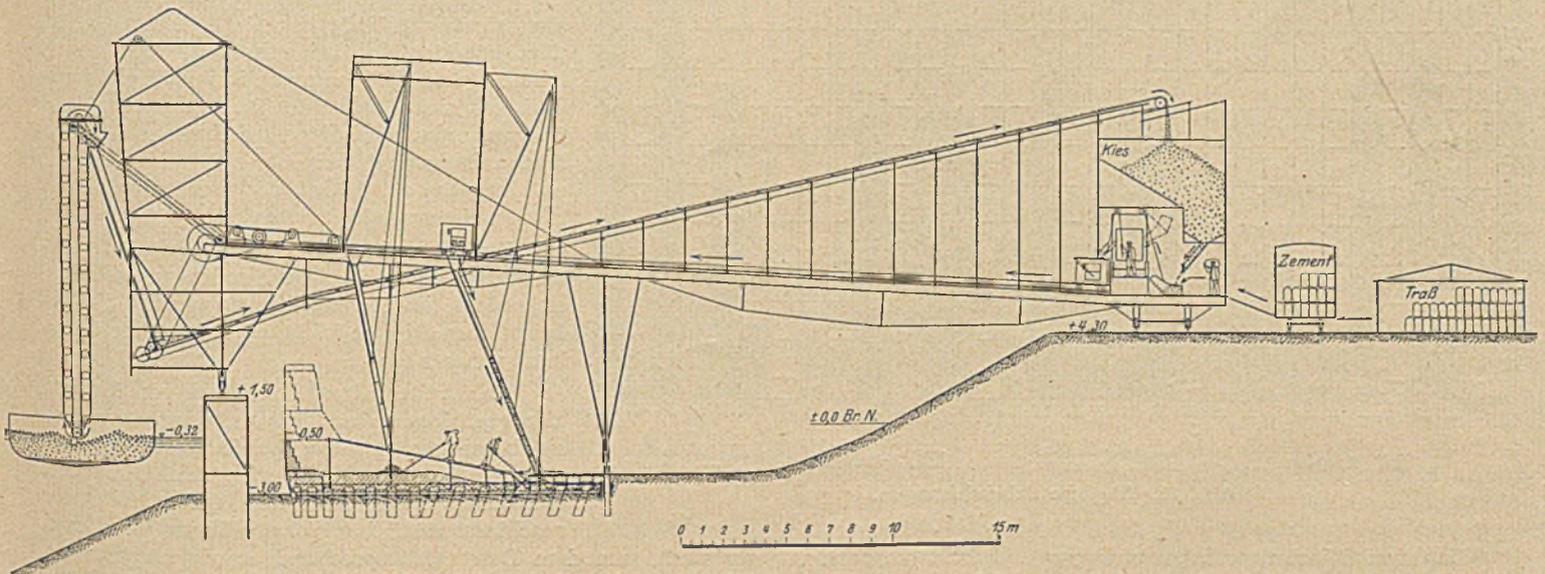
Schematische Darstellung der fahrbaren Betontransportanlage.
